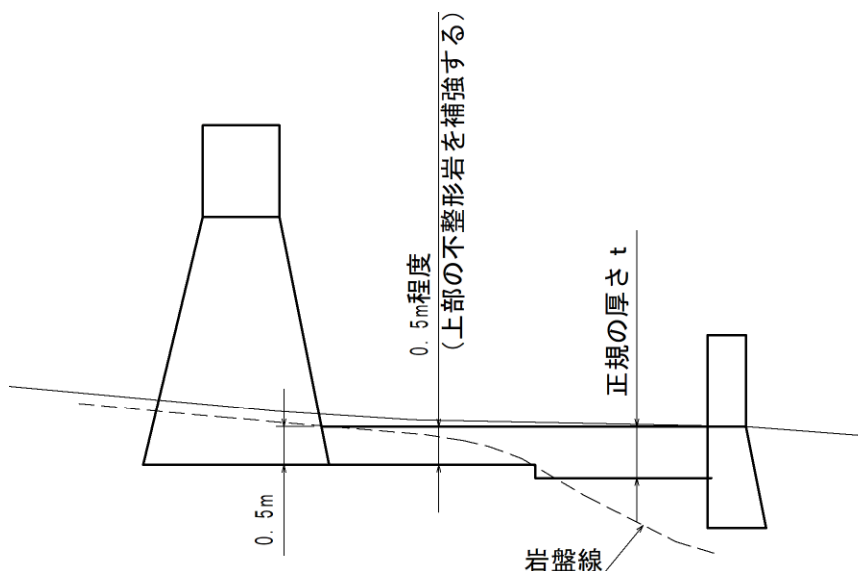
VII-2 水叩き厚さ（岩盤基礎の場合）
